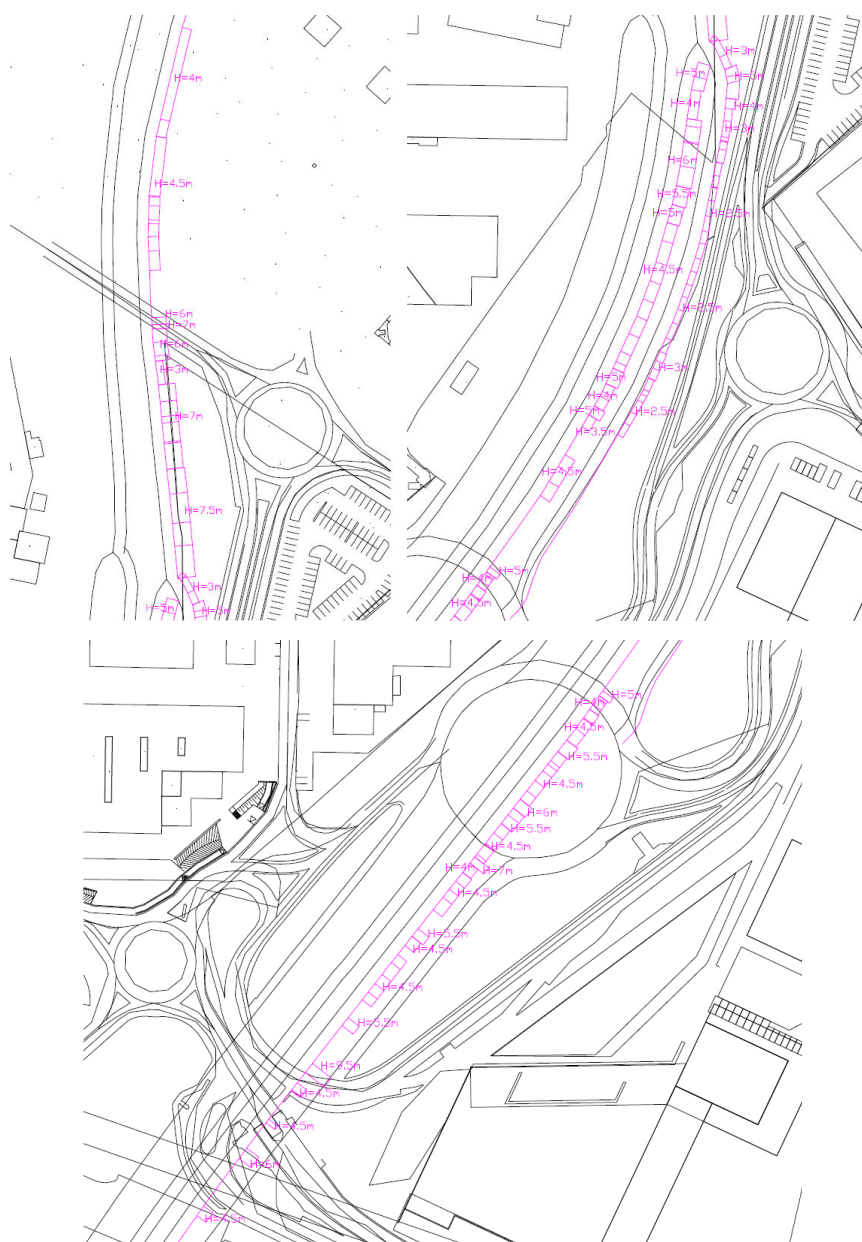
Disposizione planimetrica ed altezze del sistema di barriere ottimizzato per la A52
